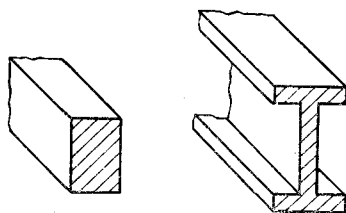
Балки прямоугольного и двутаврового поперечного сечений.
